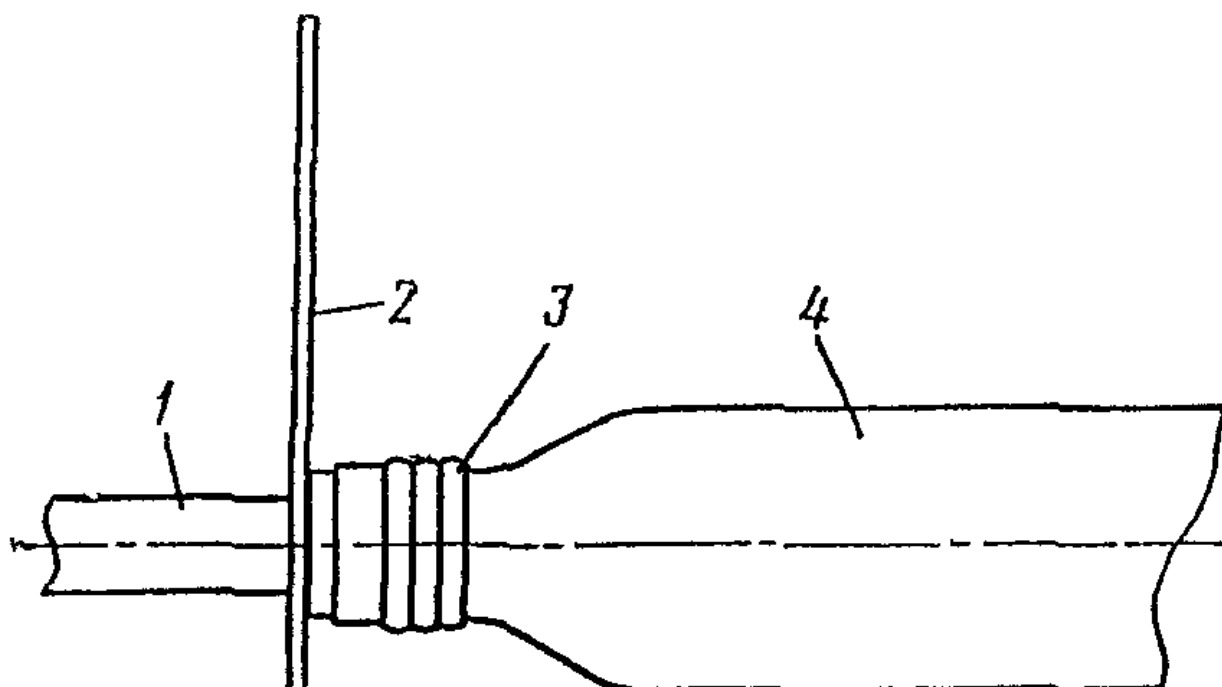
Муфта, подготовленная к сварке: 1 - кабель; 2 - вкладыши; 3 - резиновая лента; 4 - поливинилхлоридная трубка
